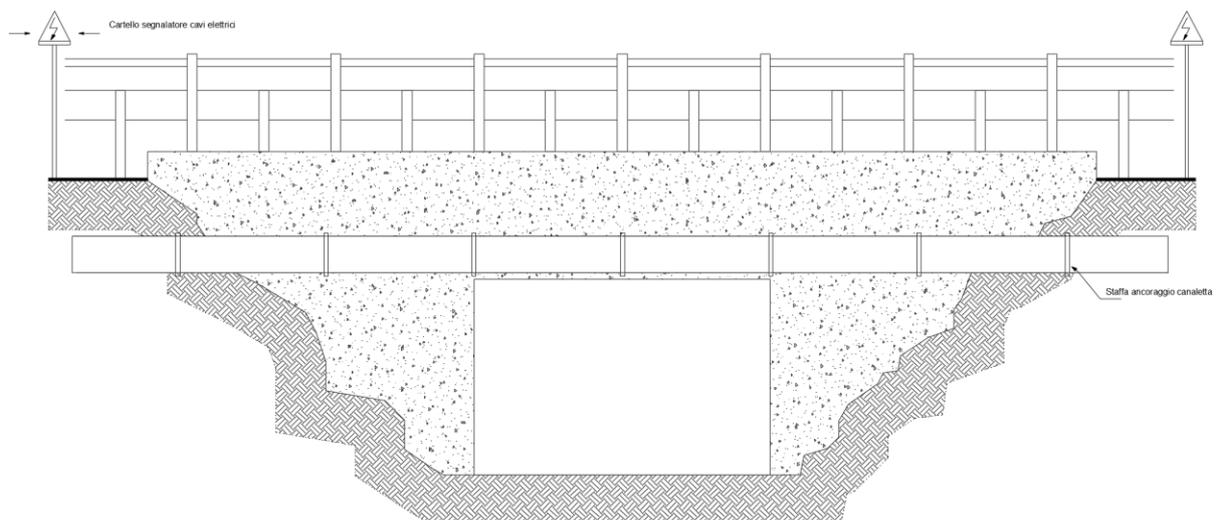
Sezione longitudinale cavidotto MT in fiancheggiamento al ponte o cavalcavia.
